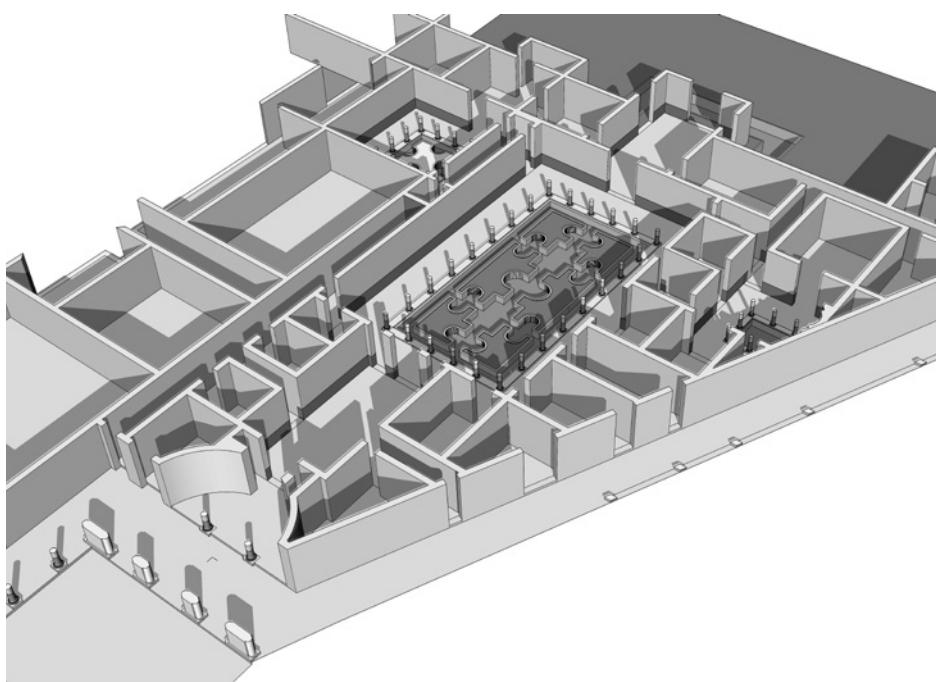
Restituição da planta da ‘Casa dos Repuxos’ em Conimbriga.
